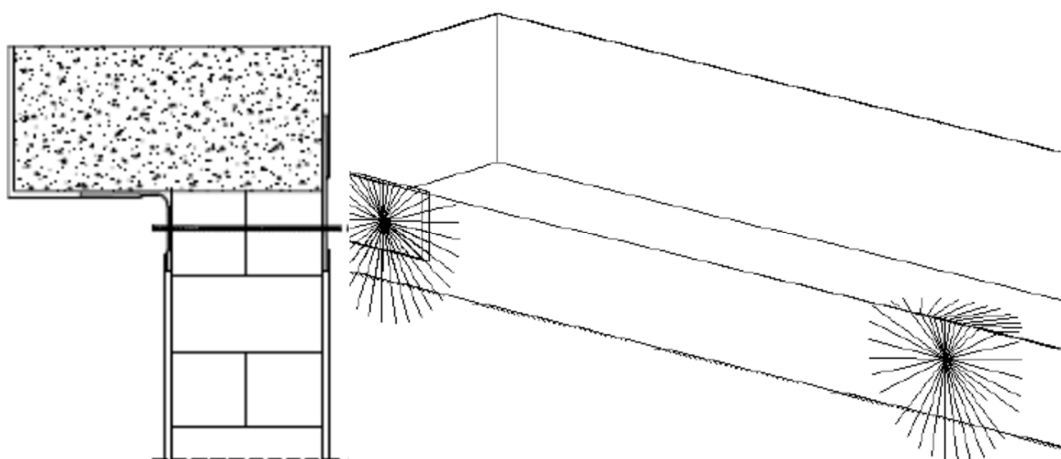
Conexión perimetral a placas y columnas (vista tridimensional): Paso 4.
